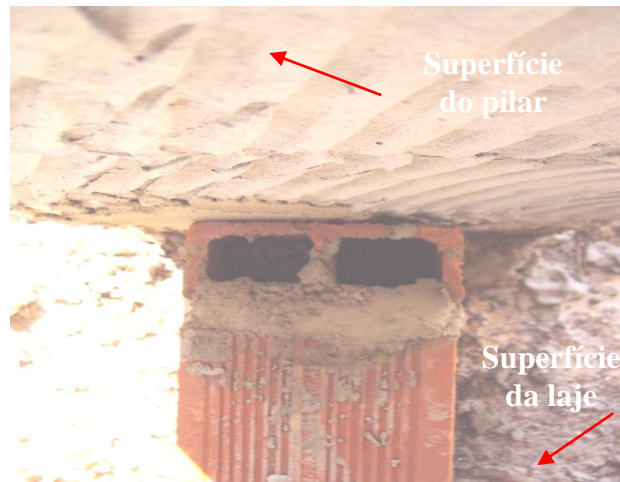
Detalhe da junta de alvenaria- pilar não totalmente preenchida de argamassa de assentamento
